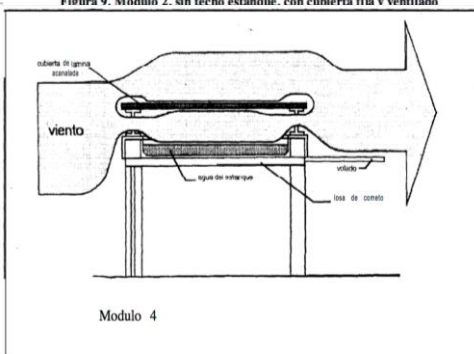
Módulo 4, techo estanque con cubierta fija y ventilado
